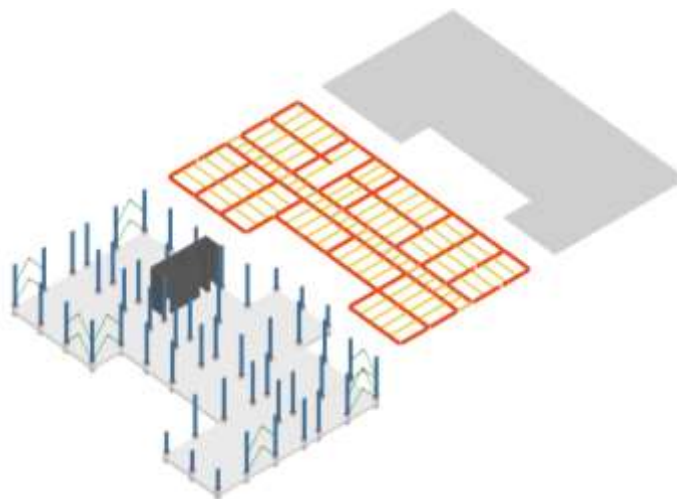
Módulo estructural. Fuente: Elaboración propia
